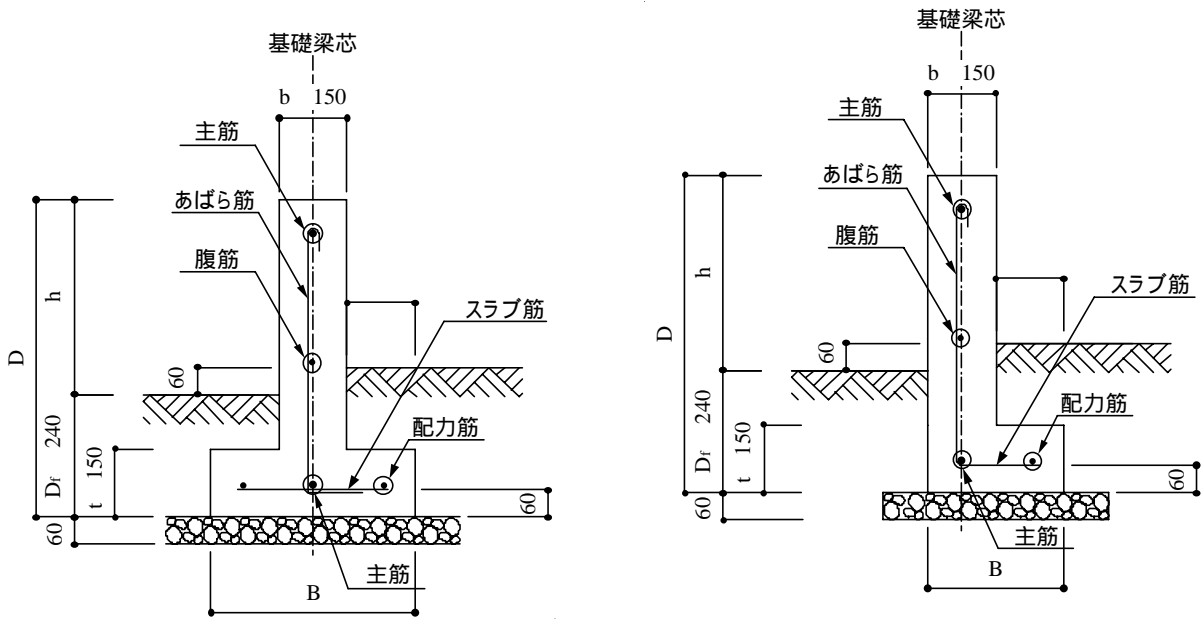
直接基礎の断面例 (布基礎・偏心布基礎)
